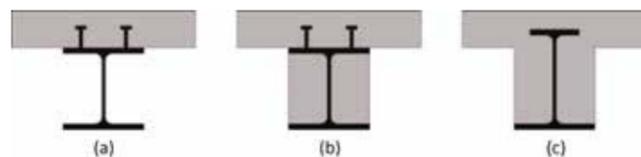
Travi Composte Acciaio-Calcestruzzo: (a) sezione convenzionale, (b) sezione partially encased, (c) SlimFloor.
